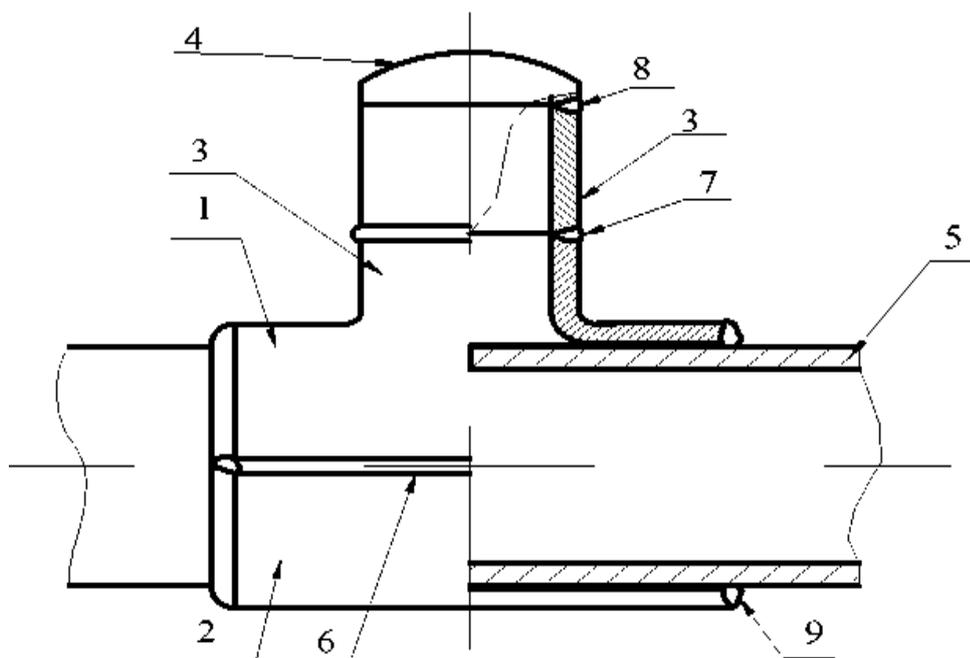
Разрезной тройник для ремонта сквозных отверстий, вантузов, патрубков и несанкционированных врезок: 1 – верхняя полумуфта; 2 – нижняя полумуфта; 3 – патрубок; 4 – эллиптическая заглушка (днище); 5 – труба; 6 – продольный стыковой шов; 7 – кольцевой сварной шов приварки патрубка к тройнику; 8 – кольцевой сварной шов приварки эллиптической заглушки (днища) к патрубку; 9 – кольцевой сварной шов приварки тройника к трубе
